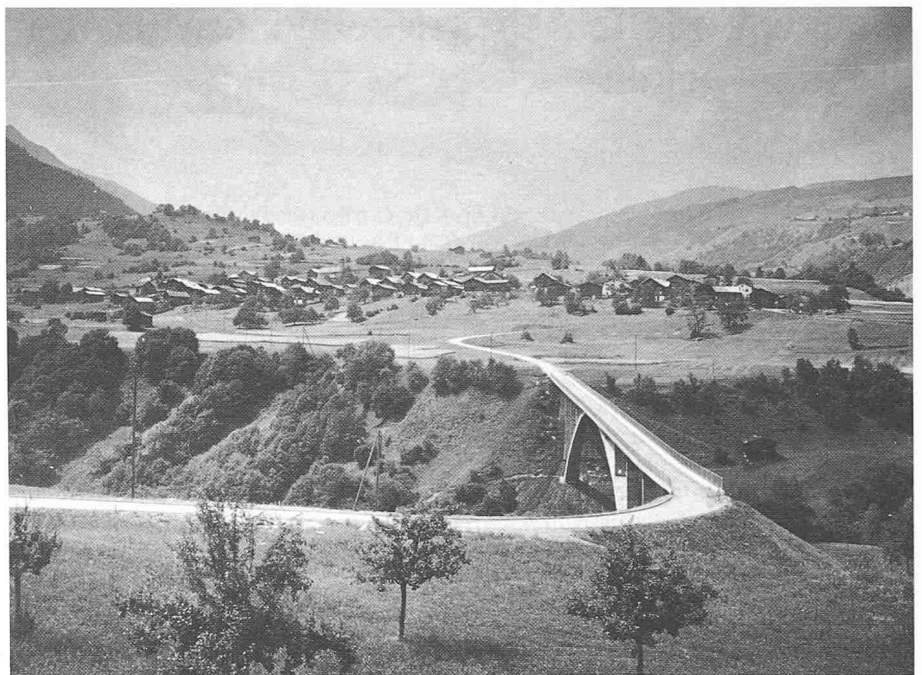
Die Strasse passte sich der Brückenbaukunst an
